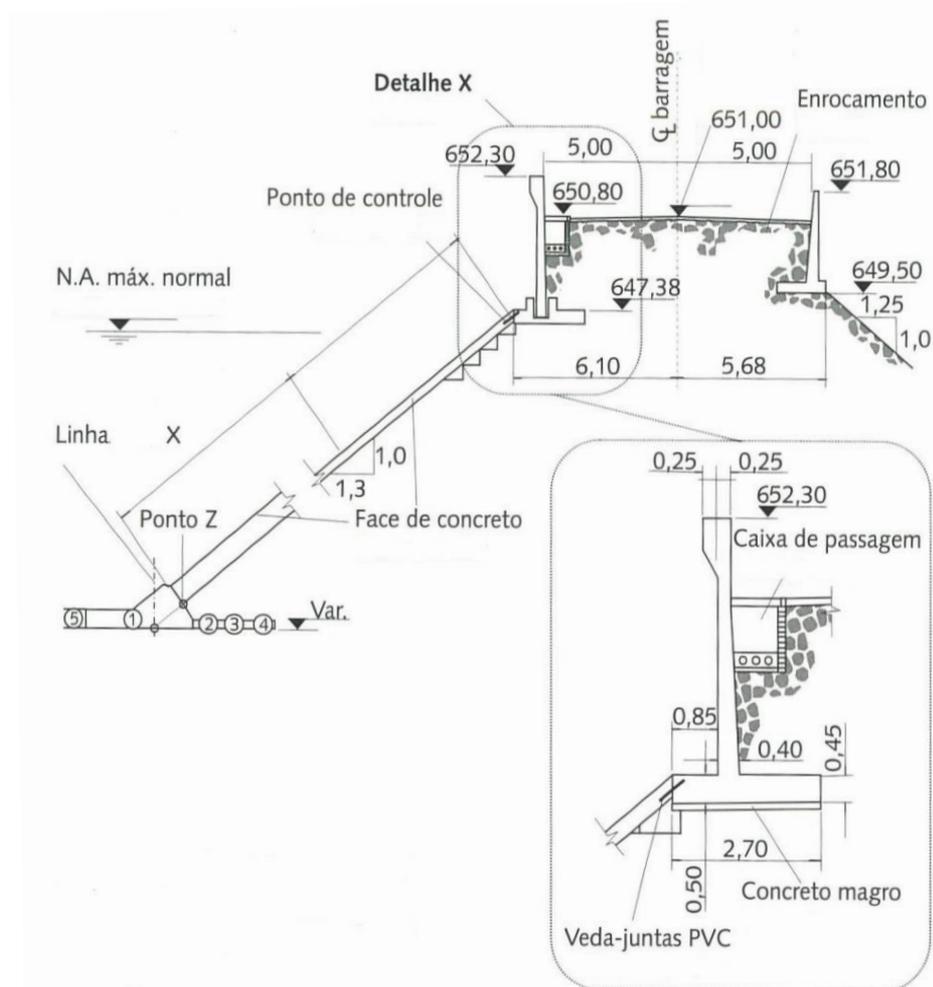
Detalhe do muro da crista e da junta de expansão no contato laje-fundação do muro da barragem de Barra Grande, RS/SC. (Fonte: CRUZ; MATERÓN; FREITAS, 2009)
